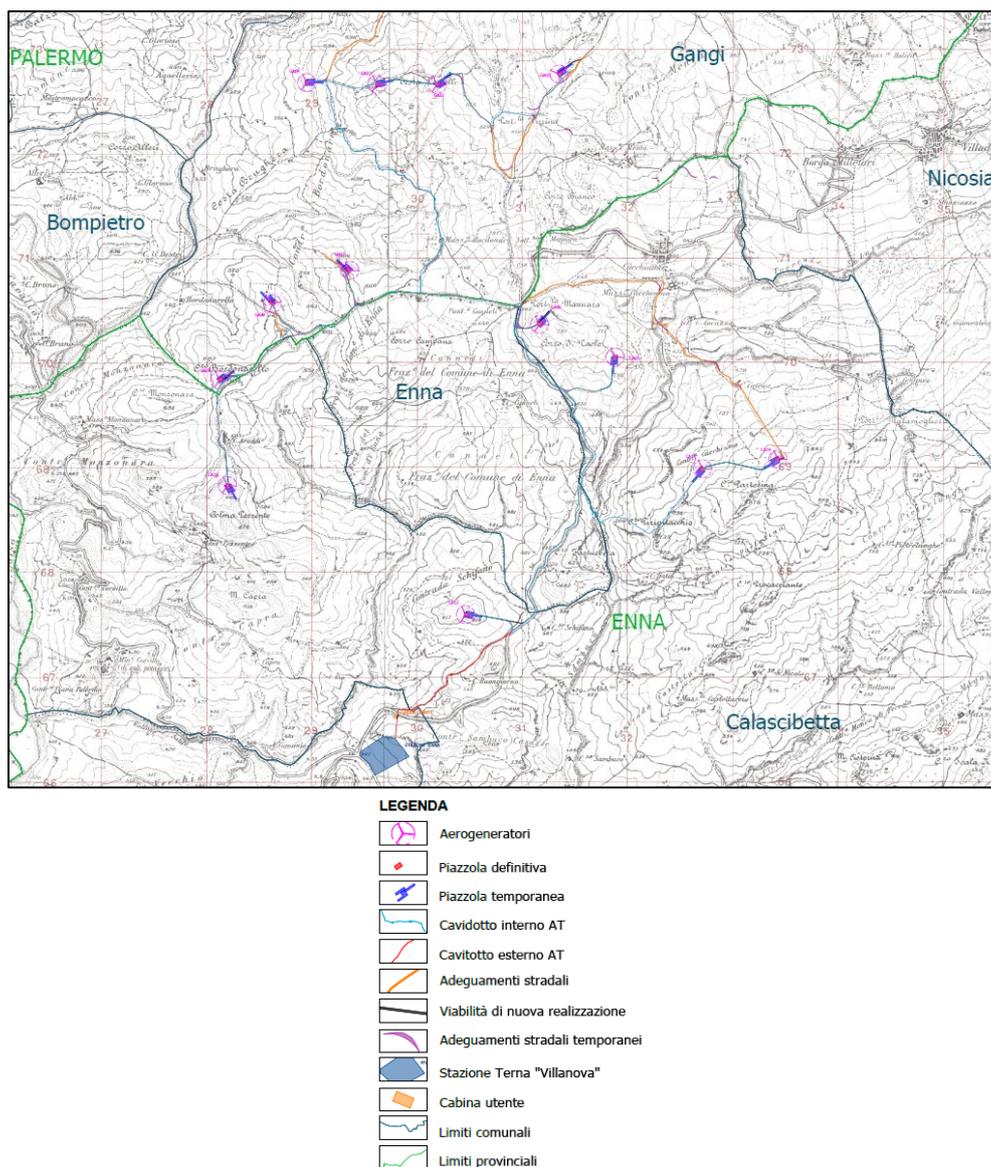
stralcio planimetrico su IGM del layout di impianto
